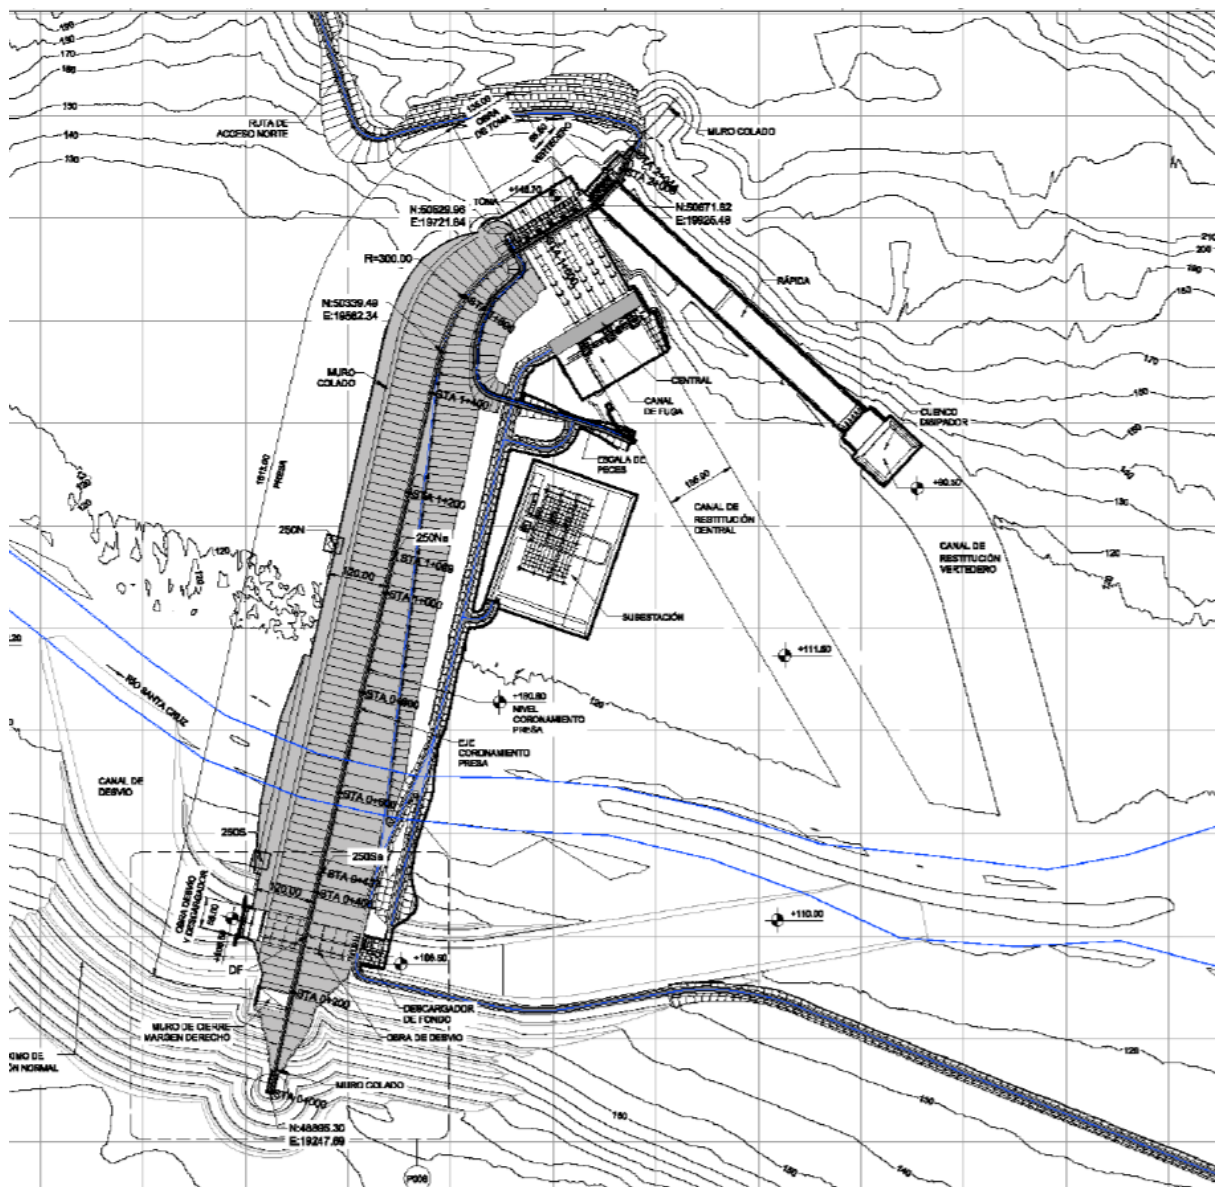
NK - Planta general de las obras (Fuente: Elaboración propia)
